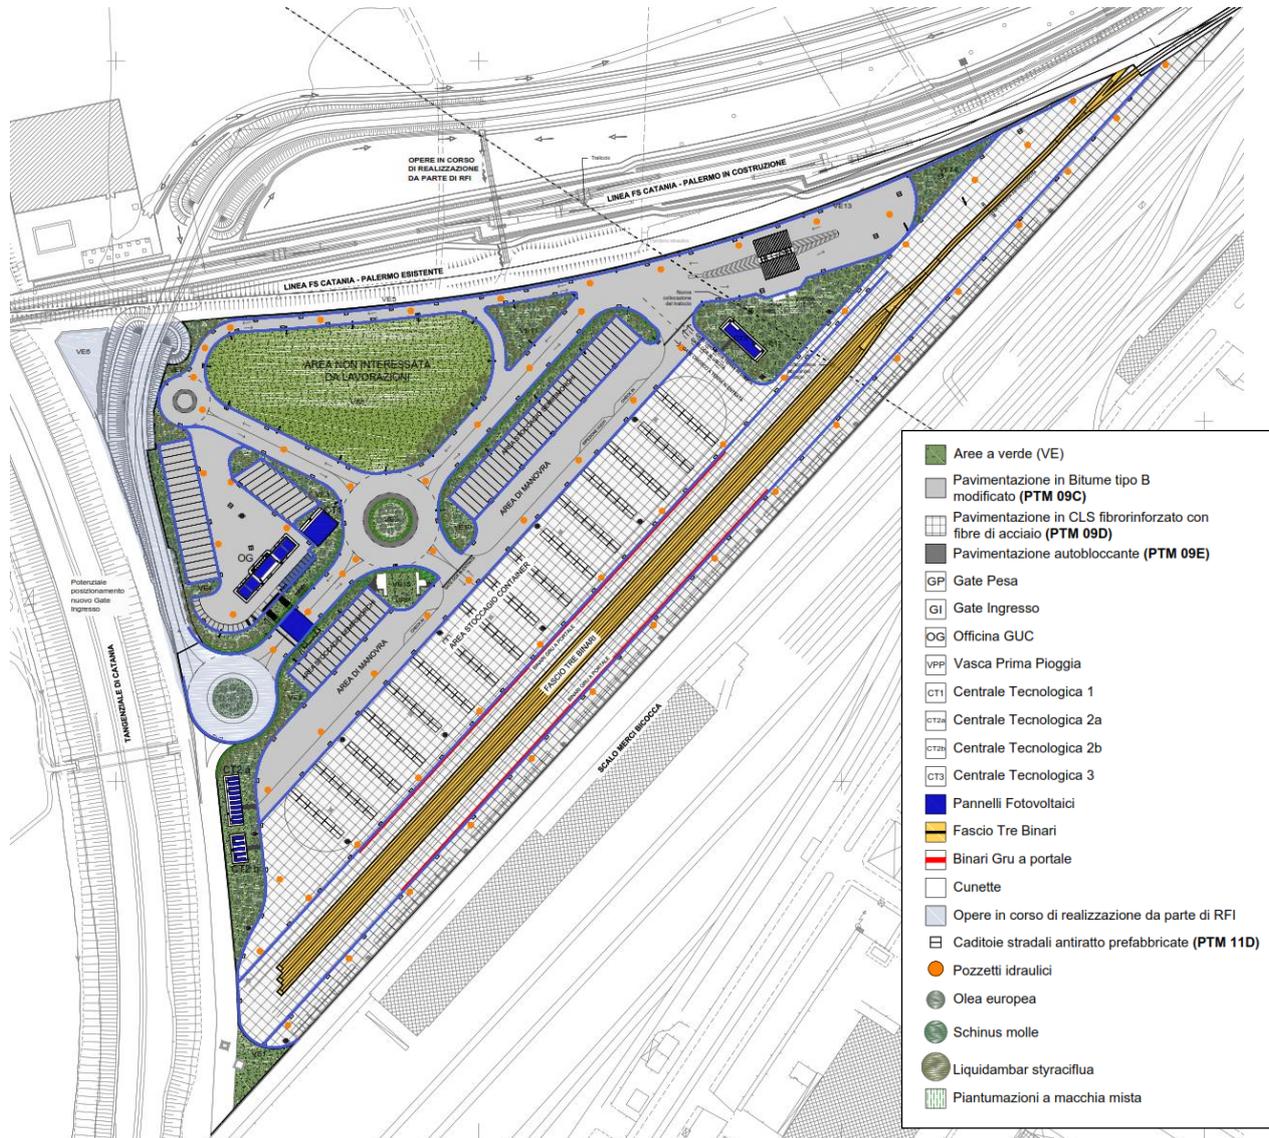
Stralcio della planimetria di progetto (elaborato di PE 00 01 03 03).
